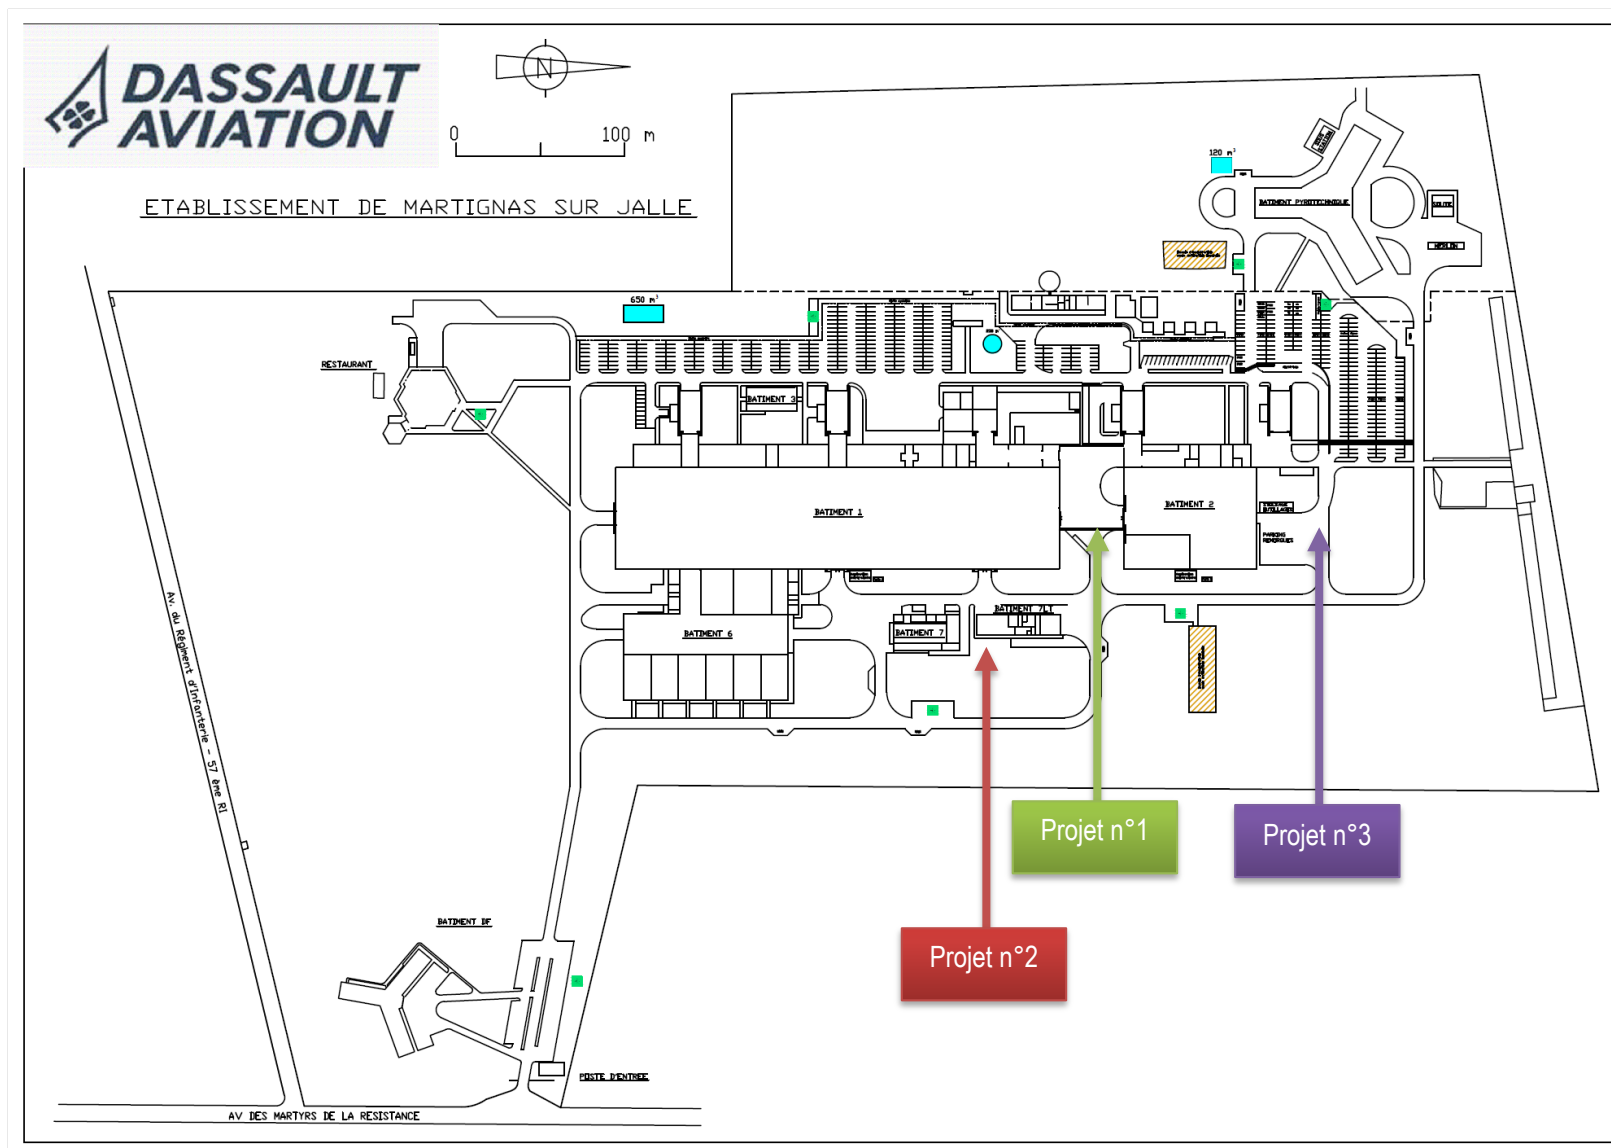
Plan du site de DASSAULT AVIATION à Martignas-sur-Jalle (source : DASSAULT AVIATION).
